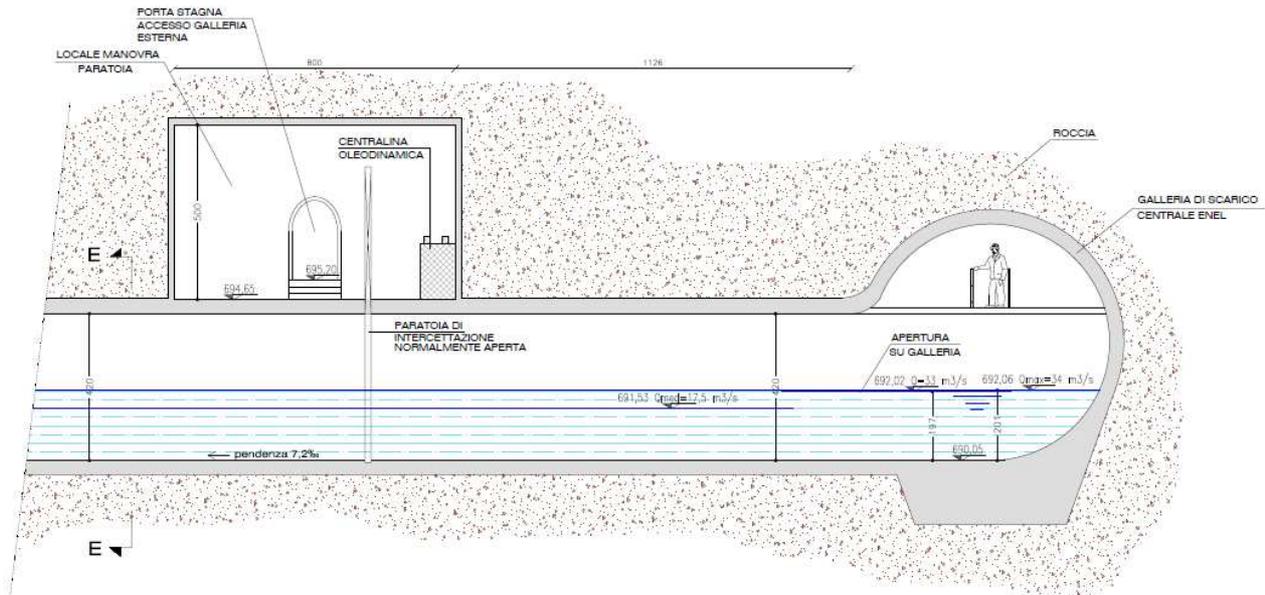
Sezione longitudinale opera di presa e imbocco galleria di derivazione
